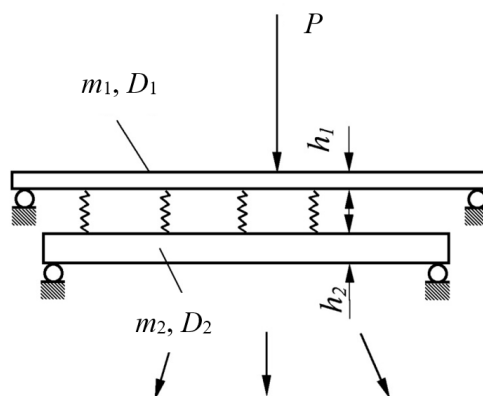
Расчетная схема перекрытия с «плавающим» полом
